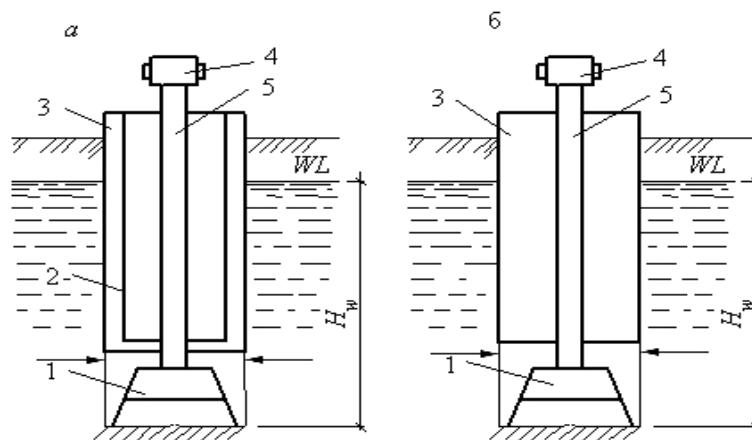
Схема влаштування фундаментів глибокого закладання кесонним методом: а – для заглибленого приміщення; б – для глибокого фундаменту; 1 – кесонна камера; 2 – гідроізоляція; 3 – надкесонне приміщення; 4 – шлюзовий апарат; 5 – труба шахтна
